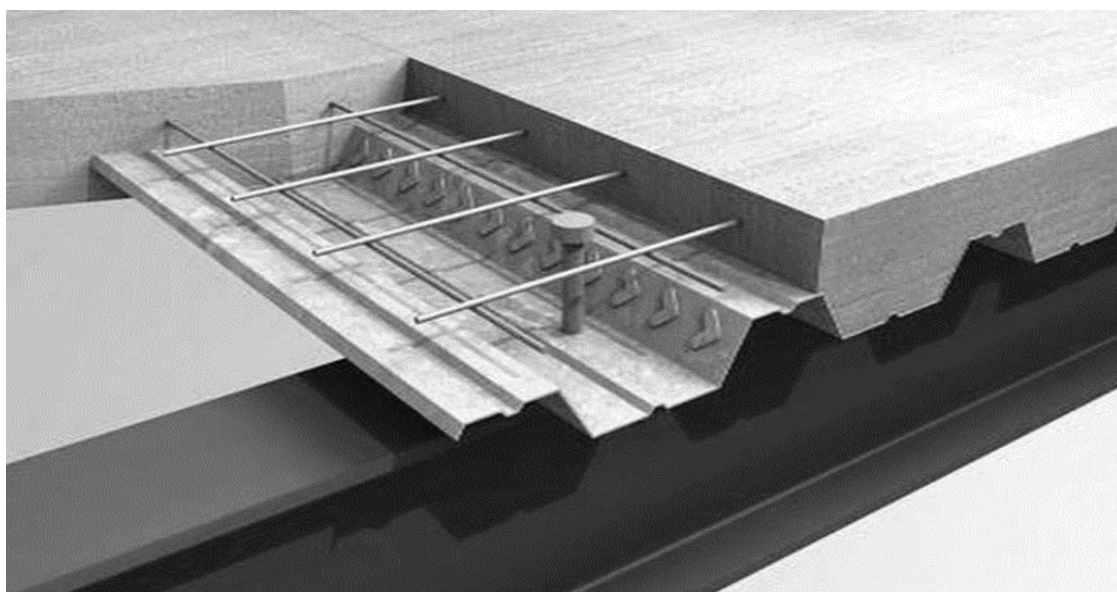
Плита перекрытия с использованием в качестве несъемной опалубки профилированного настила
